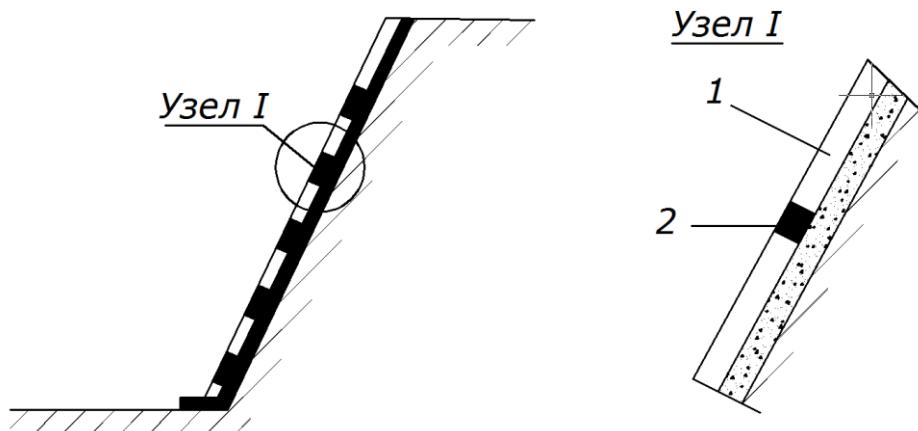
Укрепление откоса бетонными и железобетонными плитами:
